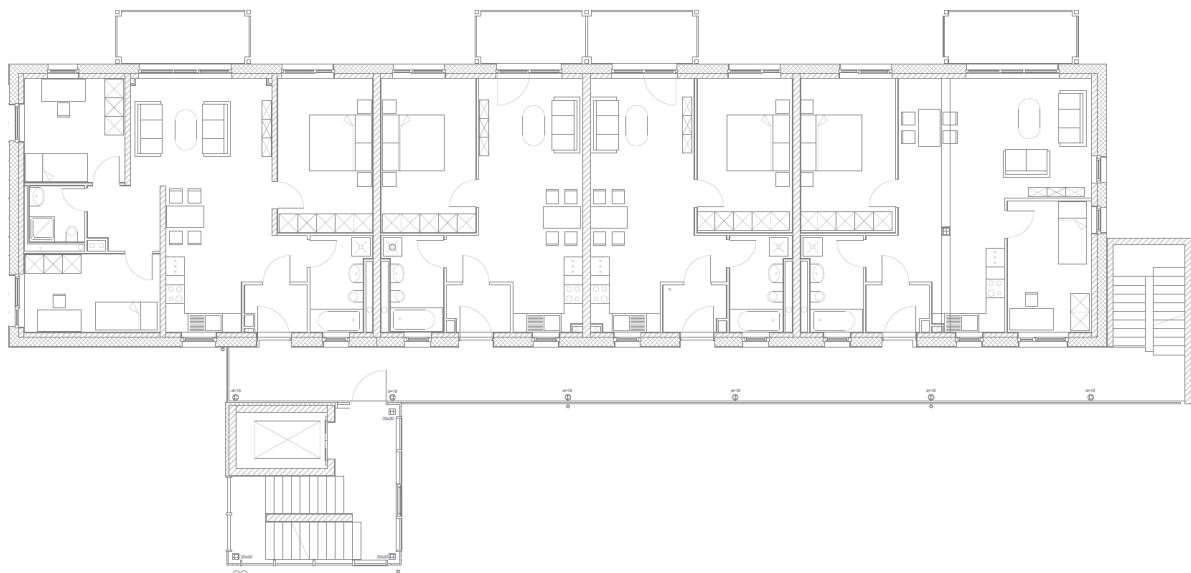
Gebäudegrundriss 2-4 OG [faktor10]
